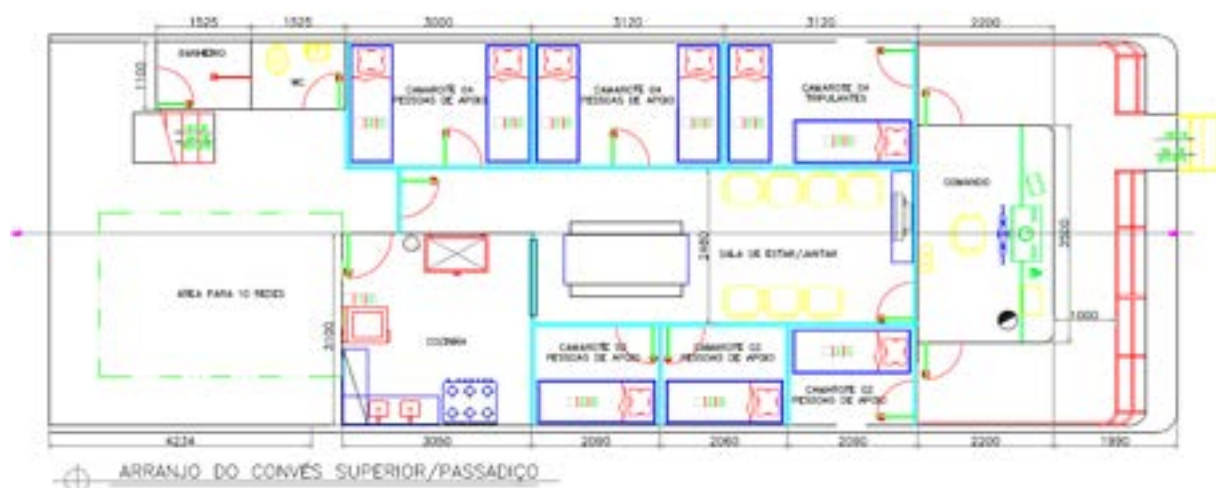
Planta baixa do segundo pavimento: alojamento e área de convivência – UBSF. Fonte: JR Express Boat
